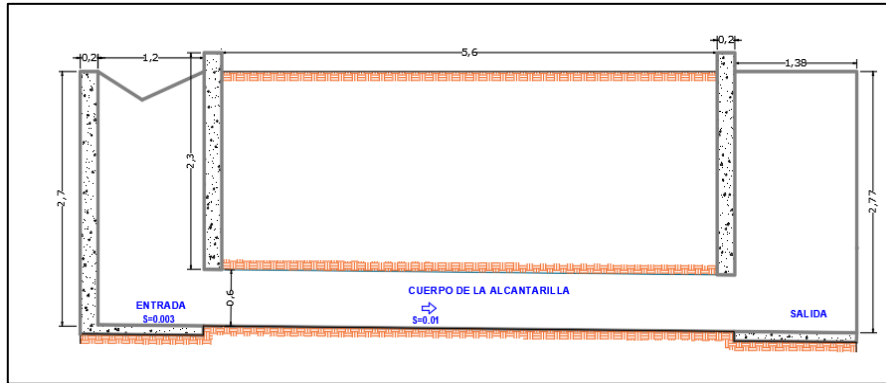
Vista en perfil de la alcantarilla N°02 existente.
